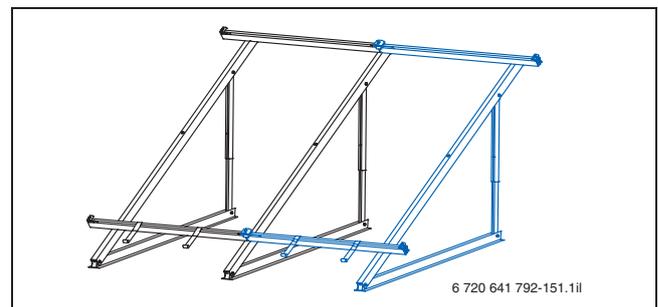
Set di base per montaggio su tetto piano e set di espansione (blu) per un collettore piano Logasol SKN4.0-s o SKS4.0-s
